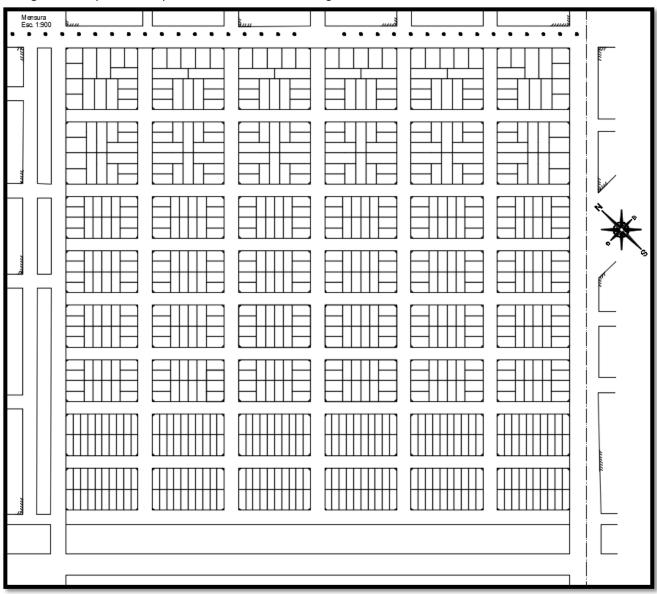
Proyecto de Subdivisión Ley 14.449 Elaboración: Propia (AutoCAD)
